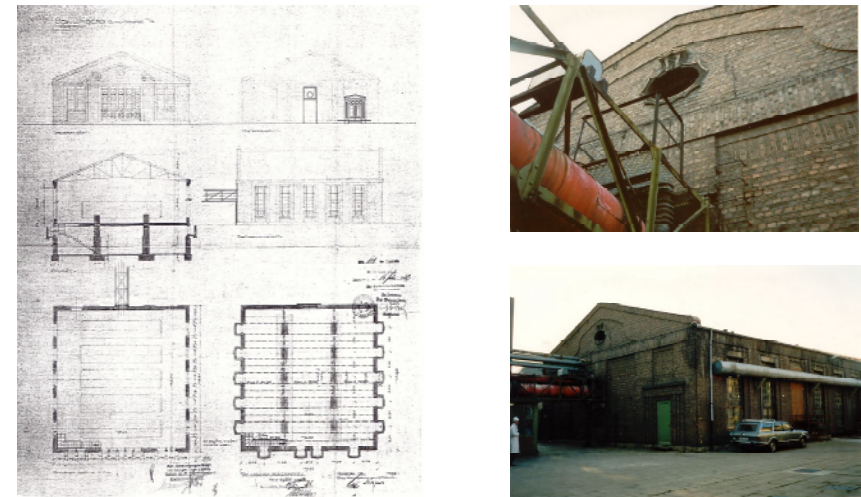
Beispiel Heizstation, Bestandsplan und Fotografie
